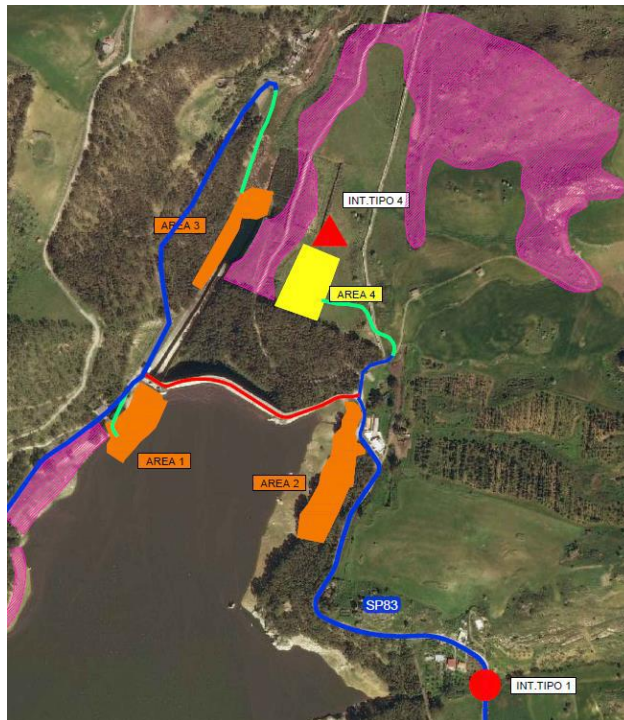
Estratto dallo SPA di aprile 2021 recante Vista di dettaglio 3
